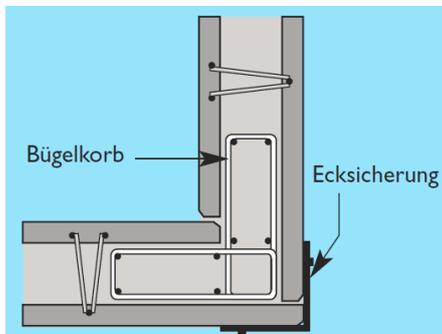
Horizontalschnitt durch eine Wandecke [SYS09]
